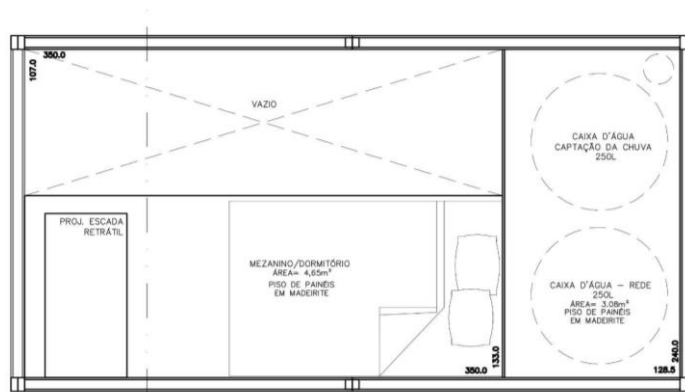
Planta Baixa - Mezanino. Fonte: Autoras (2025).
